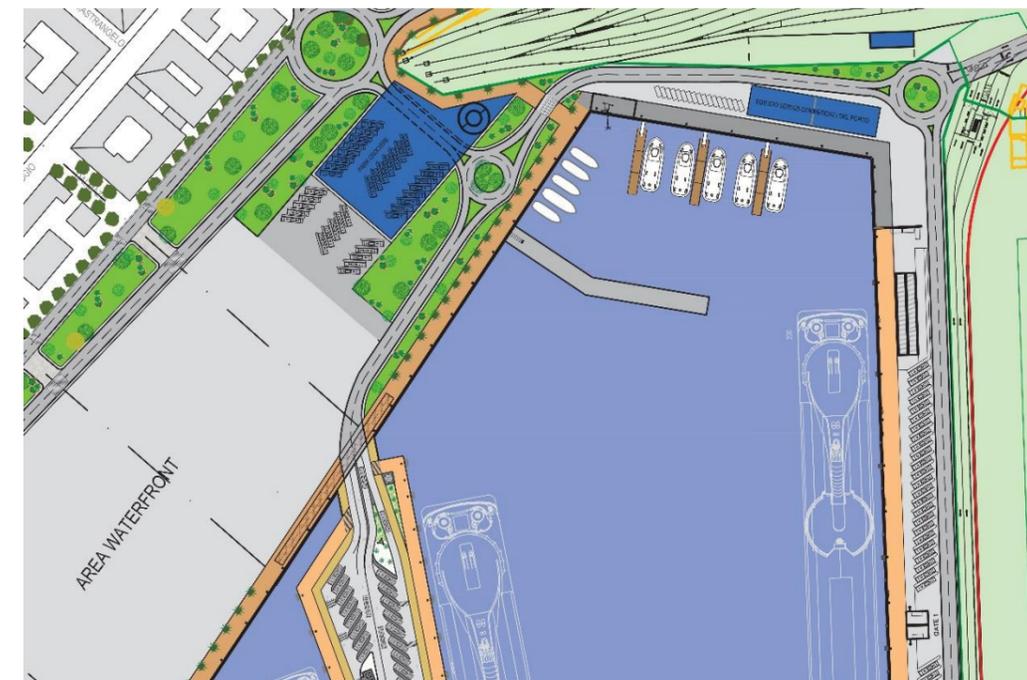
STRALCIO PLANIMETRICO DELLA NUOVA SISTEMAZIONE VIABILISTICA
